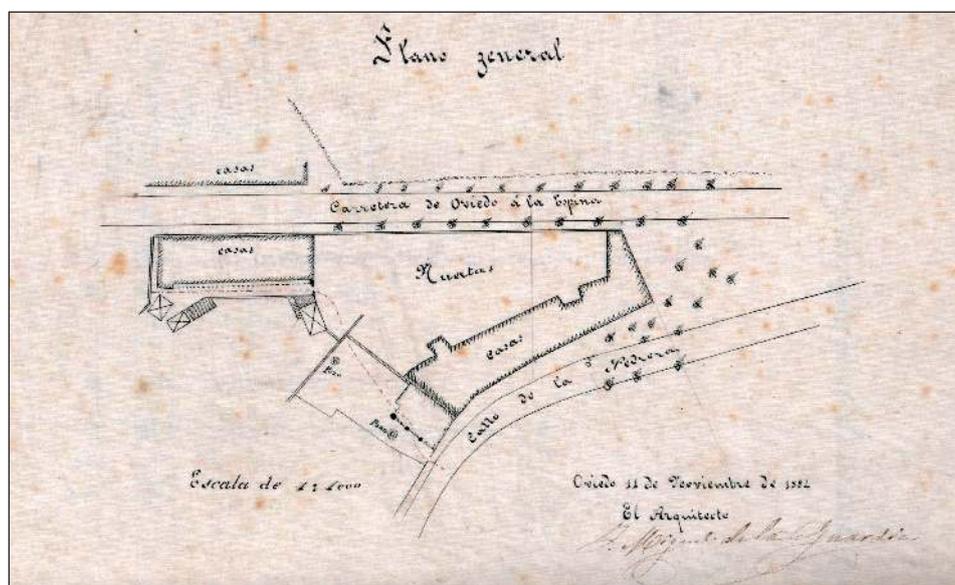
Plano realizado en 1884 para la instalación de un alcantarillado en la calle La Pedrera (AMG Sig.246).
